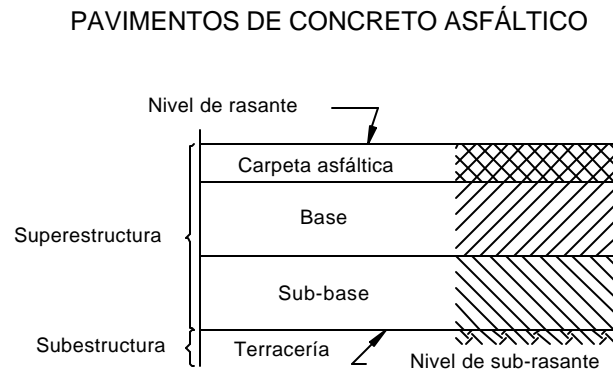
Capas y niveles en la estructura de pavimentos flexibles.
